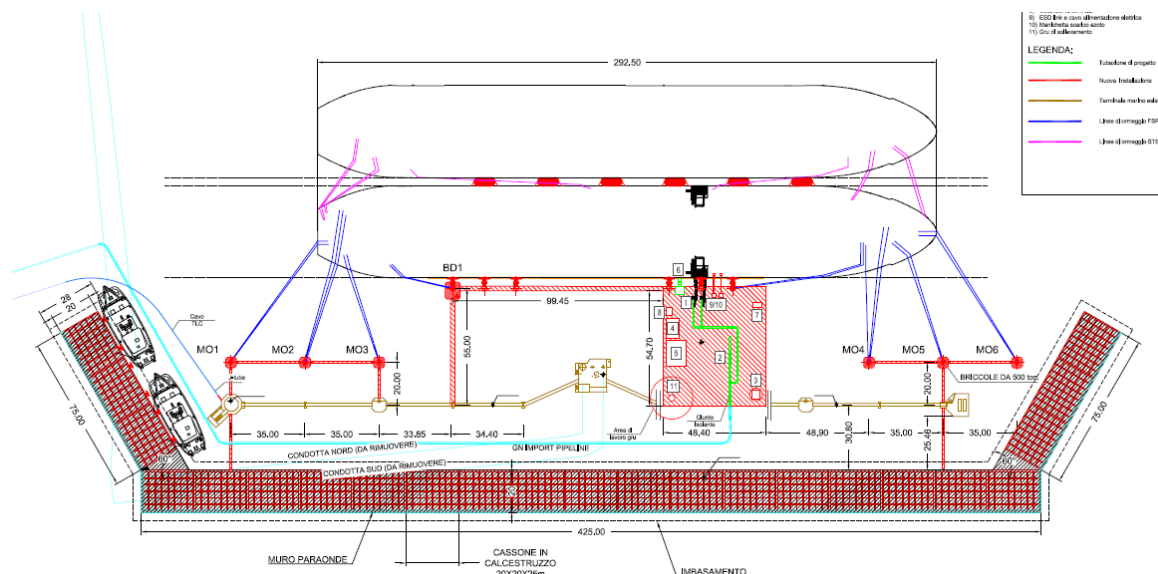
ALTERNATIVA A Layout della Piattaforma di Ormeggio PETRA – Soluzione con Cassoni
